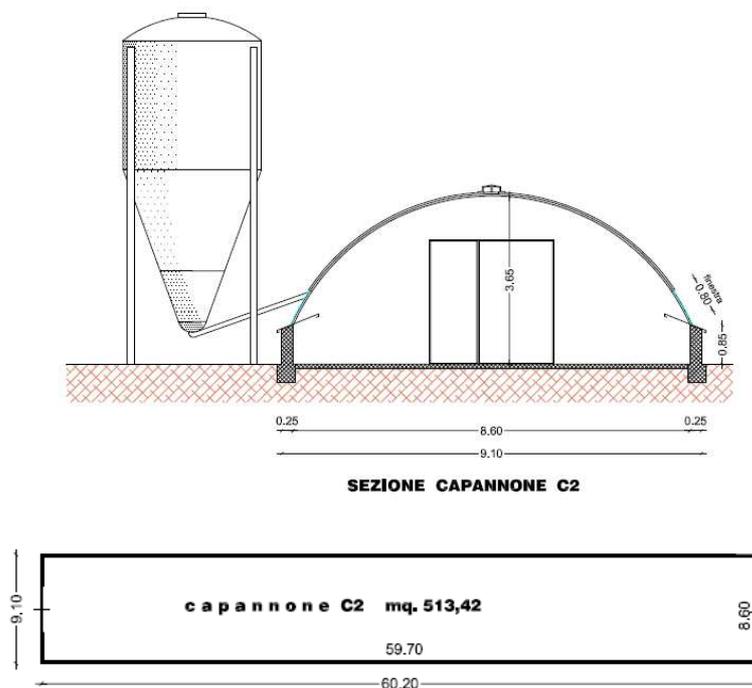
Sezione e pianta capannone C2 (fonte: A. I. A.)
